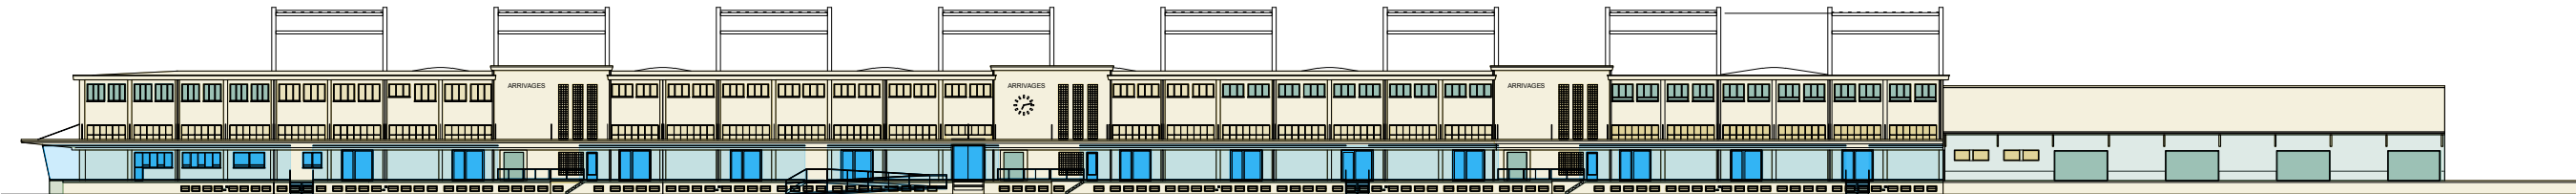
plans phases de construction coupe longitudinale, façades sud et nord
